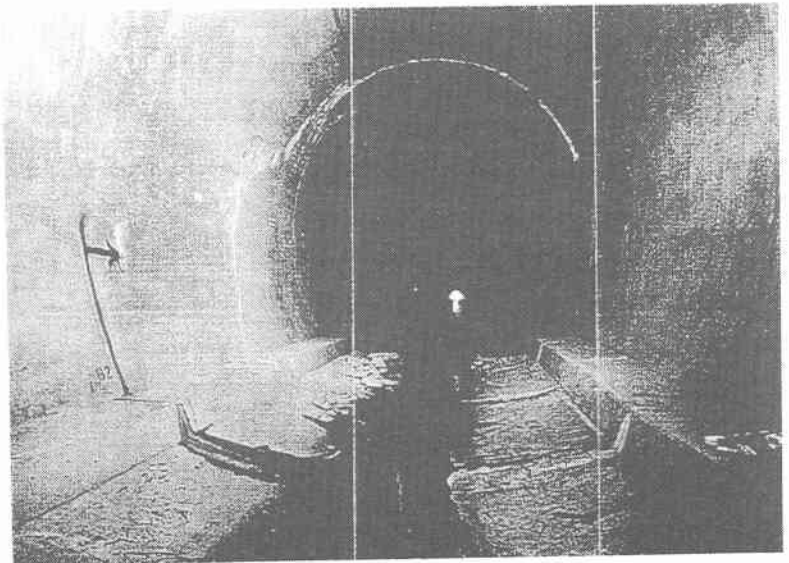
塩屋谷川放水路のリング状ひび割れ
